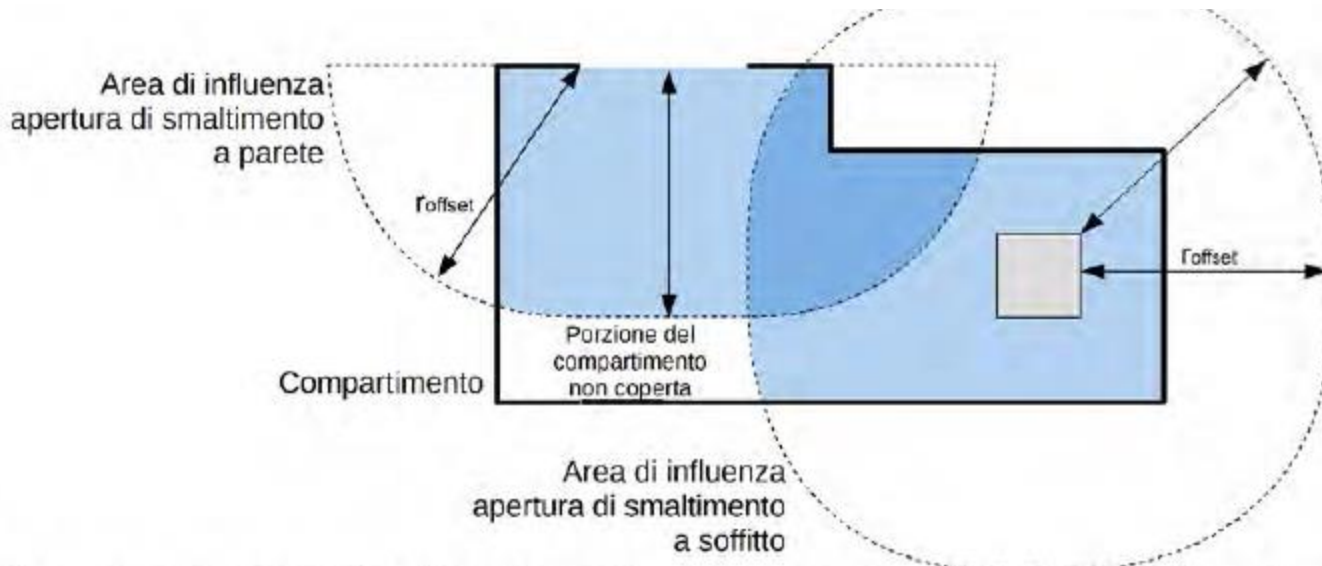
Verifica dell'uniforme distribuzione in pianta delle aperture di smaltimento
